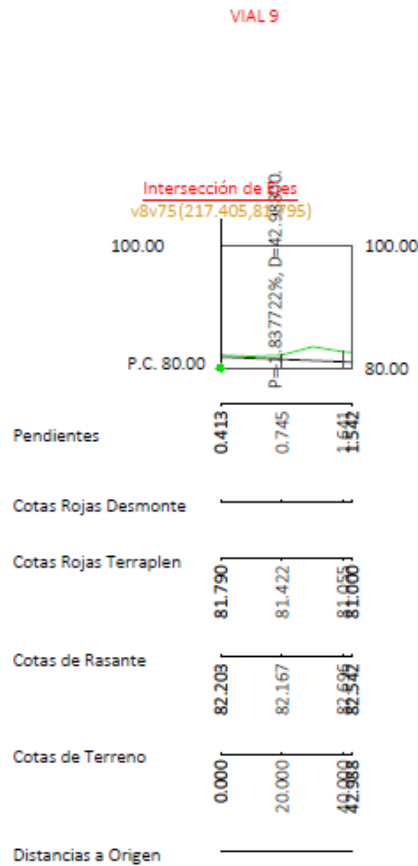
Imagen de la sección longitudinal del vial 9 en la alternativa 1.
